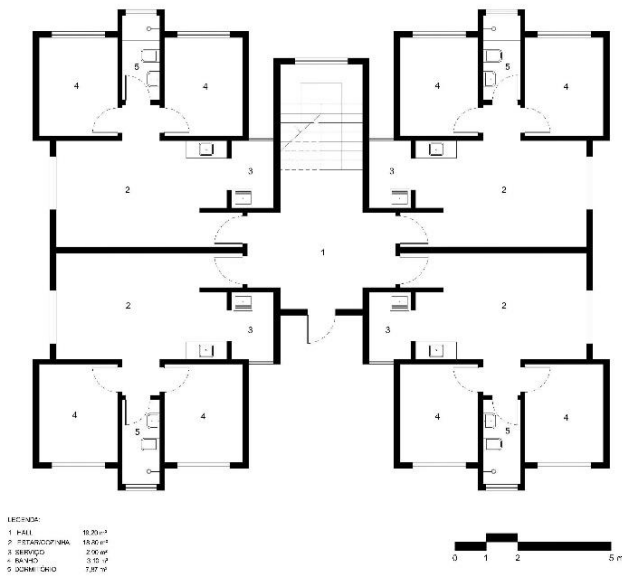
Planta baixa do Conjunto Residencial Oriental - Carazinho
